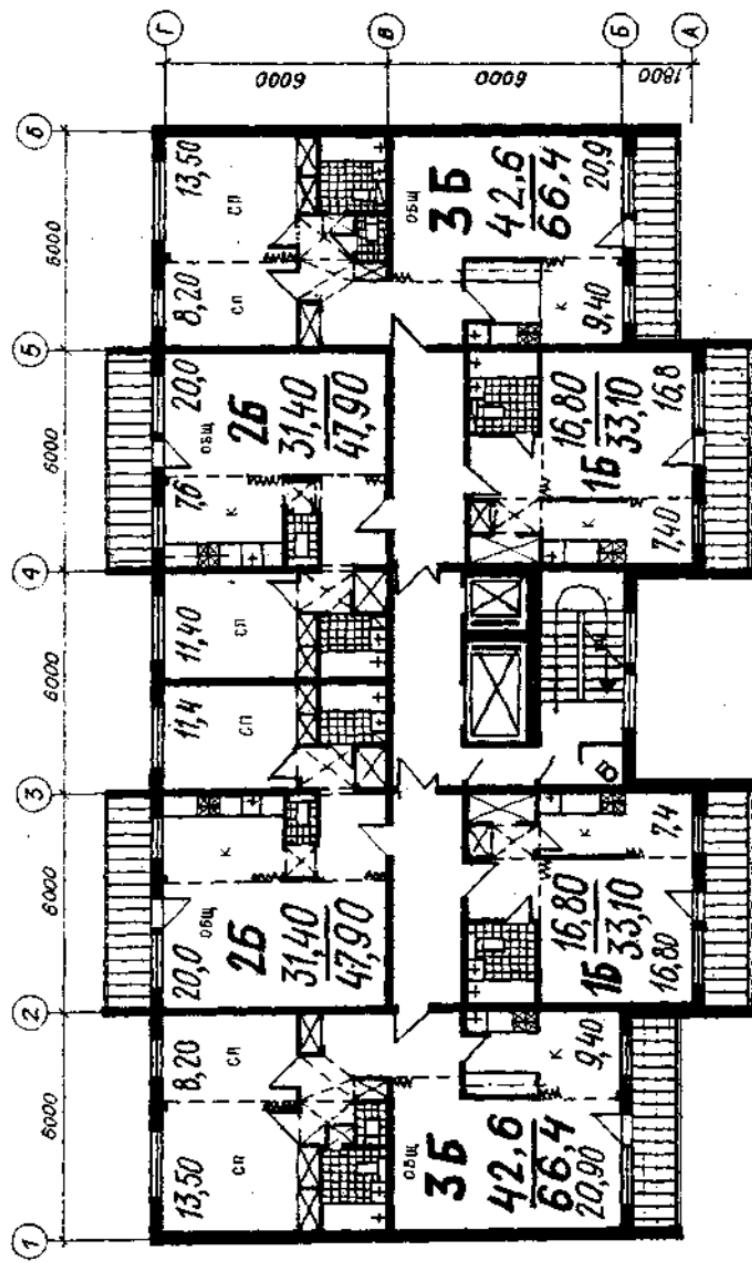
Рядовая секция типового 12-этажного жилого здания третьего поколения с широким шагом несущих поперечных стен
